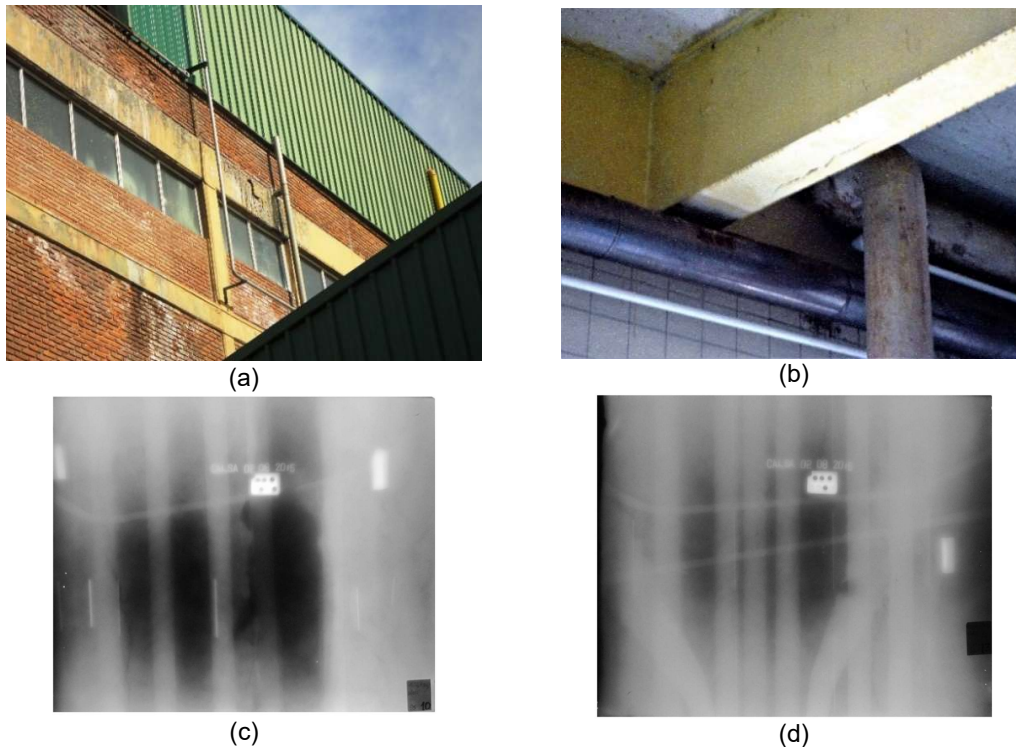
(a) Fachada de un edificio industrial con problemas de corrosión por desagües en mal estado; (b) Vista interior de d de las vigas paralelas y una transversal a la fachada de la Figura anterior. Obsérvese la fisura en la cara inferior de la viga transversal, al centro de la fotografía; (c) Gammagrafía de la viga paralela a la fachada; (d) Gammagrafía de la viga transversal a la fachada. Las oquedades se ponen en evidencia por las manchas oscuras en las gammagrafías: una falta de material deriva en una mayor intensidad de radiación y por lo tanto mayor densidad fotográfica.
